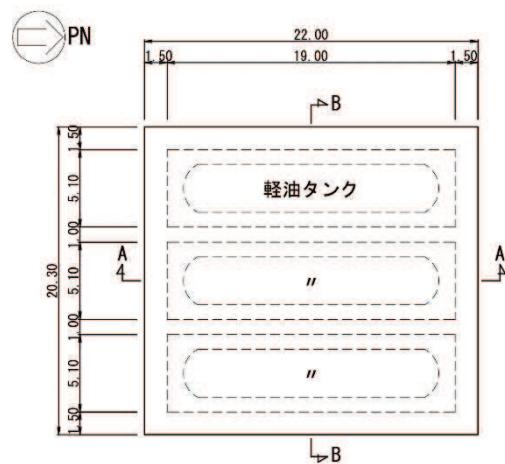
ガスタービン発電設備軽油タンク室平面図
